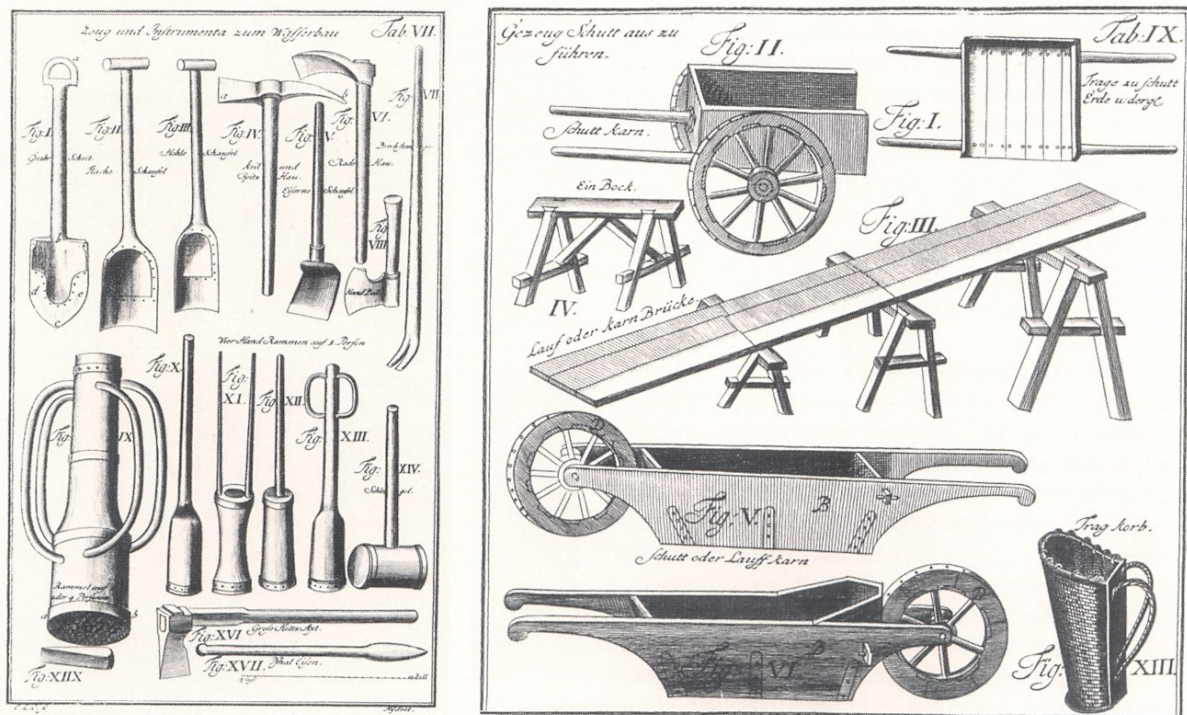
«Zeug und Instrumente zum Wasserbau» und «Gezeug Schutt auszuführen», nach Jacob Leupold 1724.
